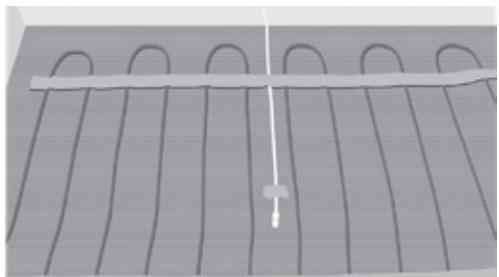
Placer le tuyau de conduit/capteur entre deux câbles
